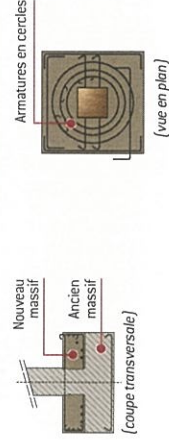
Fondations : sans augmentation de la surface de semelle (coupe transversale)
